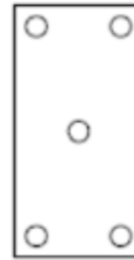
Plans de chevillage – panneaux de dimensions 1200 × 600 mm
